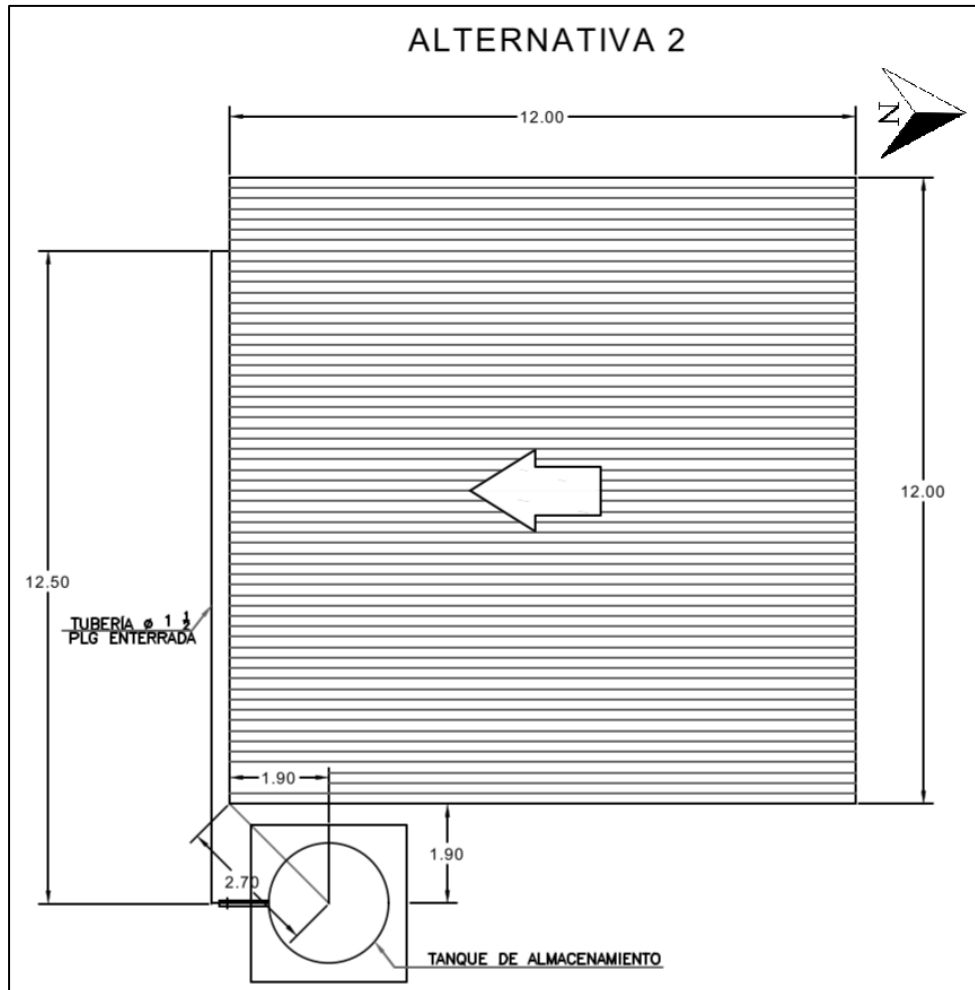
Alternativa propuesta para ubicación de tuberías de distribución
